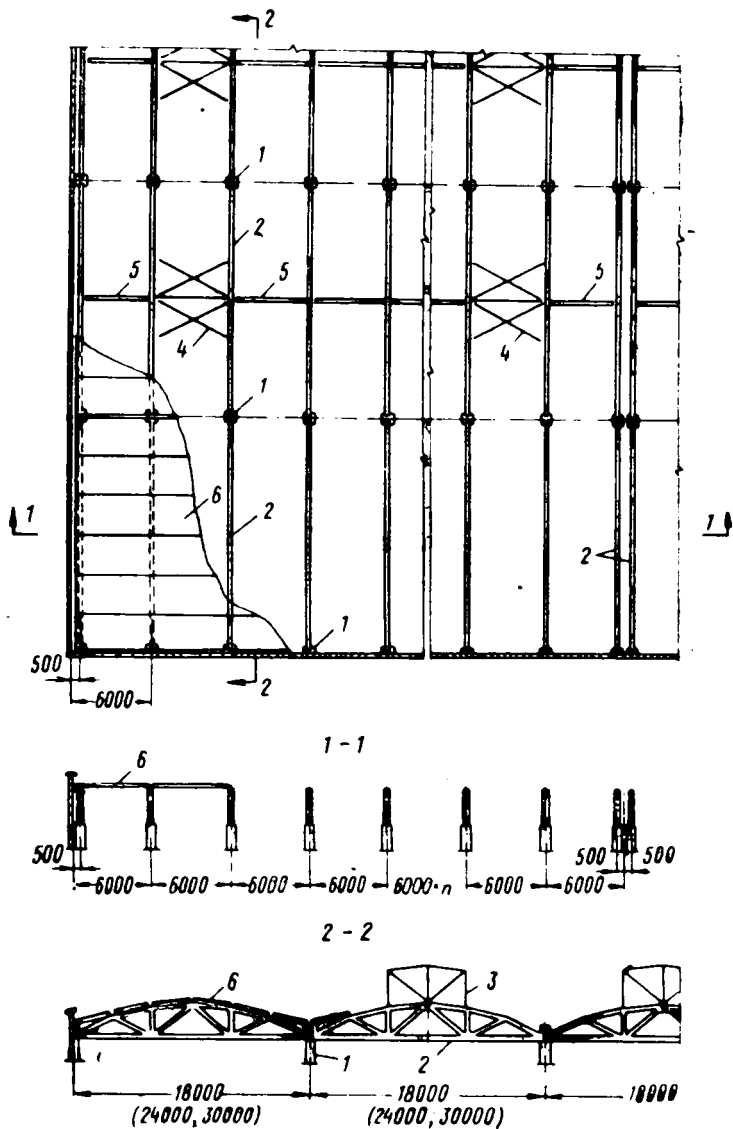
Конструктивная схема I покрытия зданий со скатной кровлей при шаге колонн 6 м
